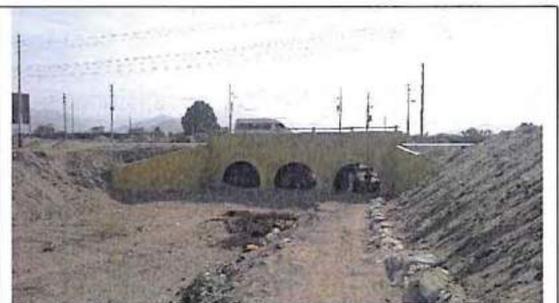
Vista aguas arriba del puente alcantarilla del llamado cauce norte.
